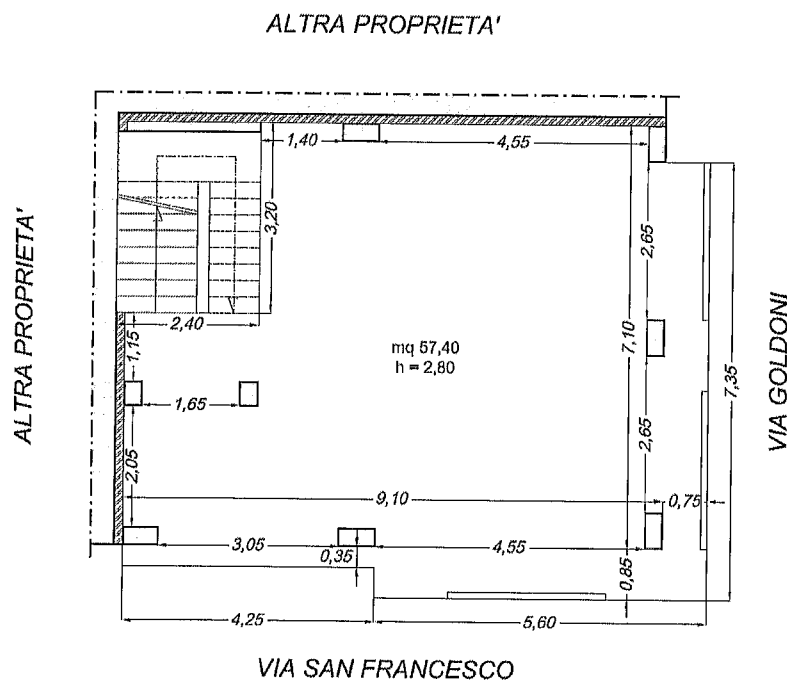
Planimetria Stato di Fatto Piano Secondo.
